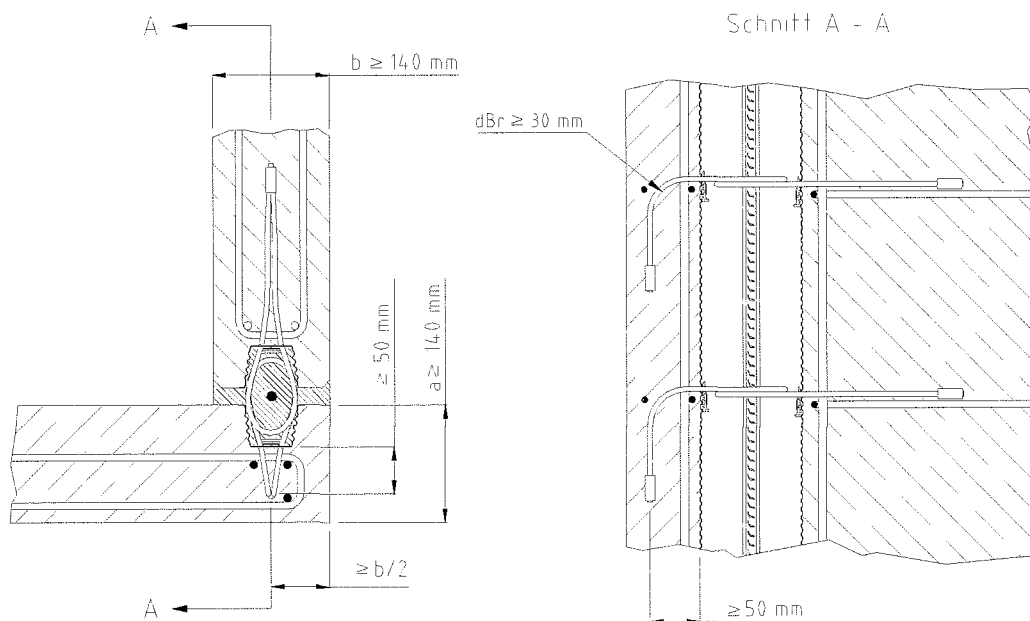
Wand – Wand – Eckverbindung - Detail bei abgewinkelter Seilschleufe
